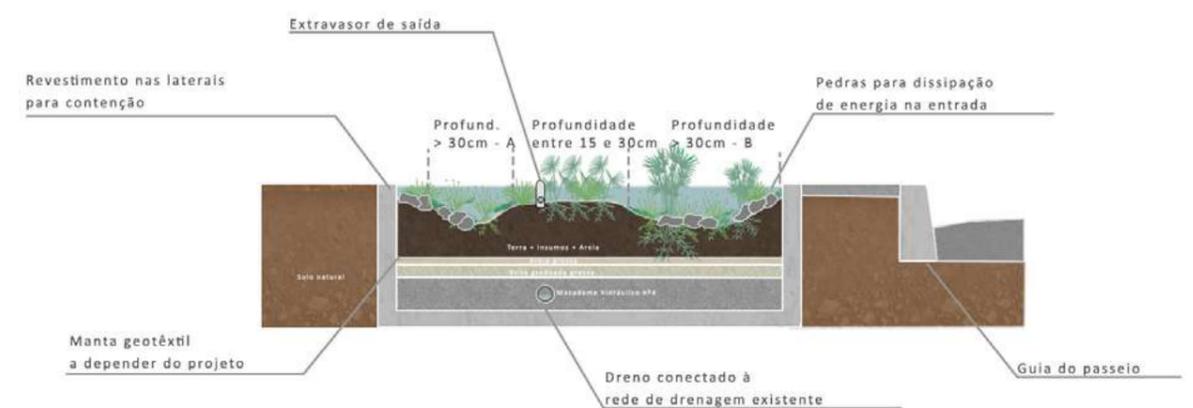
Canteiro pluvial com paredes laterais e laje de fundo, com tubulação/duto de conexão com drenagem convencional existente (Fonte: Guajava, 2023)
